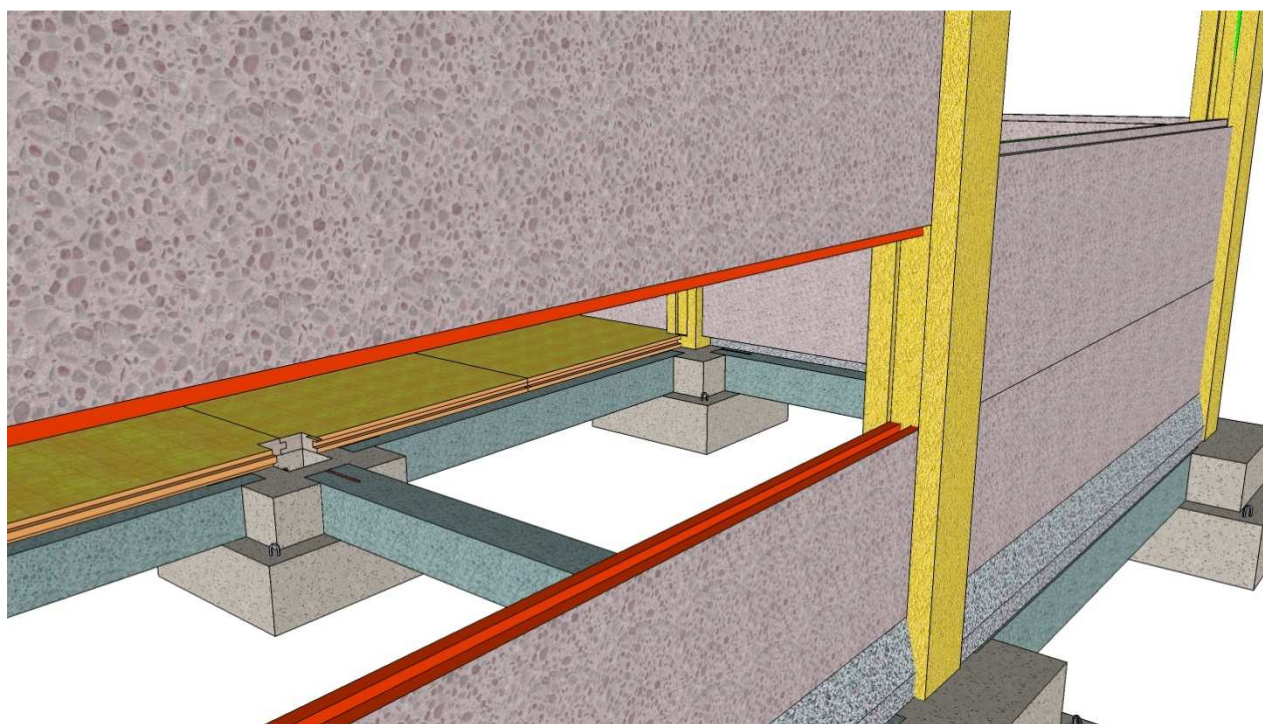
assemblage par emboîtement (Panneau extérieur avec poteau)
